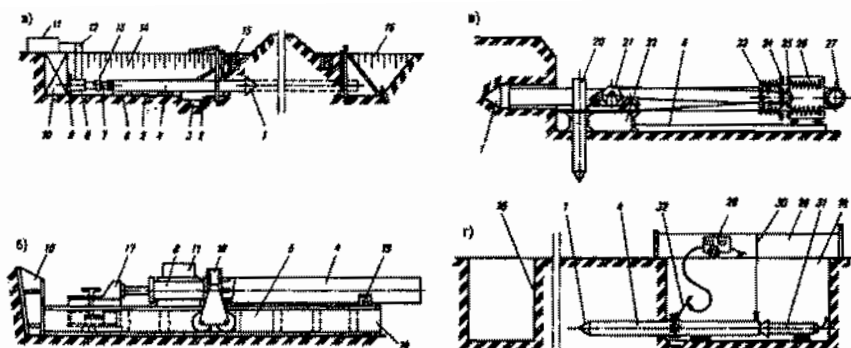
Способы прокола труб: а - общая схема работ; б - прокол установкой ГПУ-600; в - вибропрокол установкой УВВГП-400; г - прокол труб с помощью вибропробойников; 1 - наконечник; 2, 3 - приемки; 4 - прокалываемая труба; 5 - шпалы; 6 - направляющая рама; 7 - нажимной патрубков; 8 - гидродомкраты; 9 - опорный башмак; 10 - упорная стенка; 11 - насосная станция; 12 - маслопроводы; 13 - нажимная заглушка; 14, 16 - рабочий и приемный котлованы; 15 - обводной лоток; 17 - подвижный упор; 18 - нажимная плита на тележке; 19 - фиксатор; 20 свая; 21 - лебедка; 22 - рама; 23 - планка; 24 - ударная приставка; 25 - направляющие стержни; 26 - вибрационный механизм; 27 - электродвигатель; 28 - электросварочный агрегат; 29 - при-чалка; 30 - отвес; 31 - пневмопробойник; 32 - сварка труб
